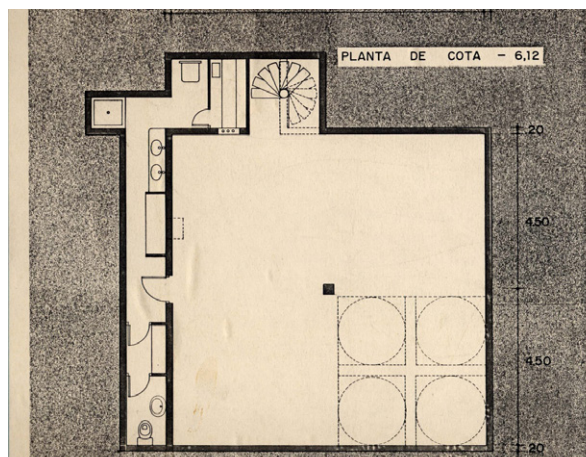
Planta del estudio. Nivel -2 (cota -6,12). Original del proyecto
